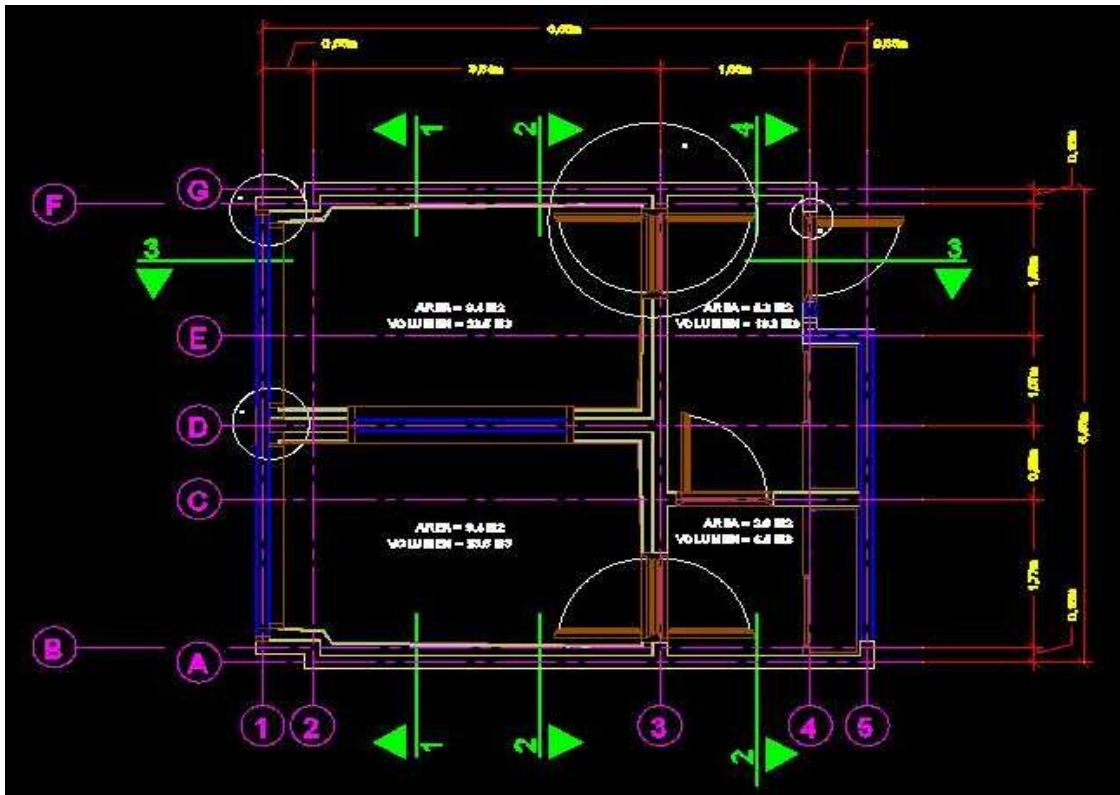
PLANTA DEL DISEÑO DE LA PROPUESTA
